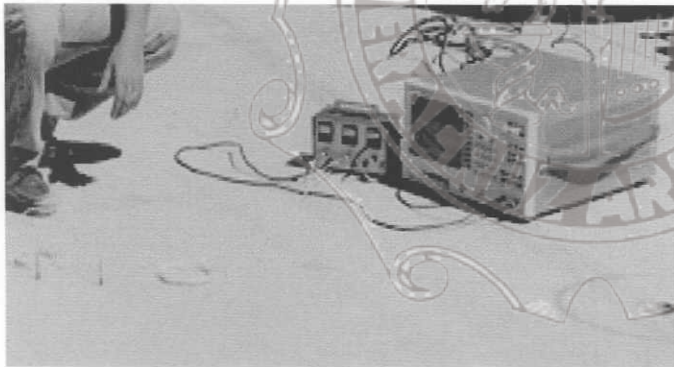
Prueba No Destructiva Aplicada al Pavimento
